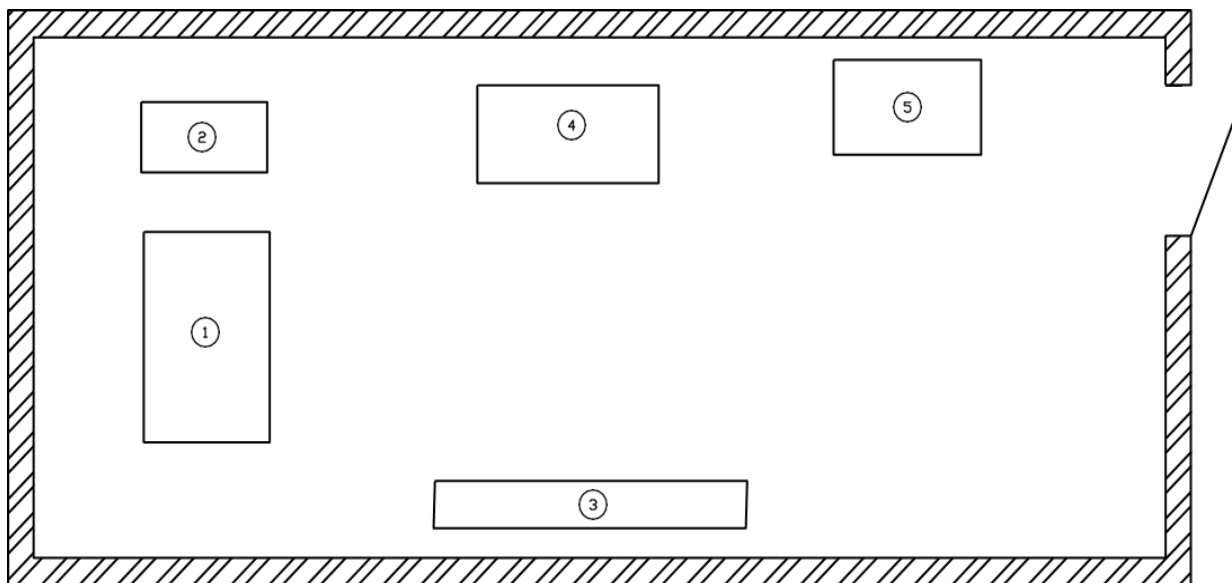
План размещения оборудования в сварочной мастерской
